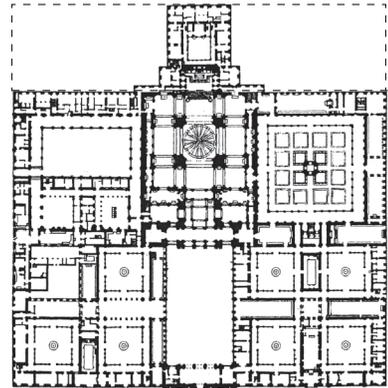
サン・ロレンツォ・エル・デ・エスコリアル 平面図 1563-1584年
